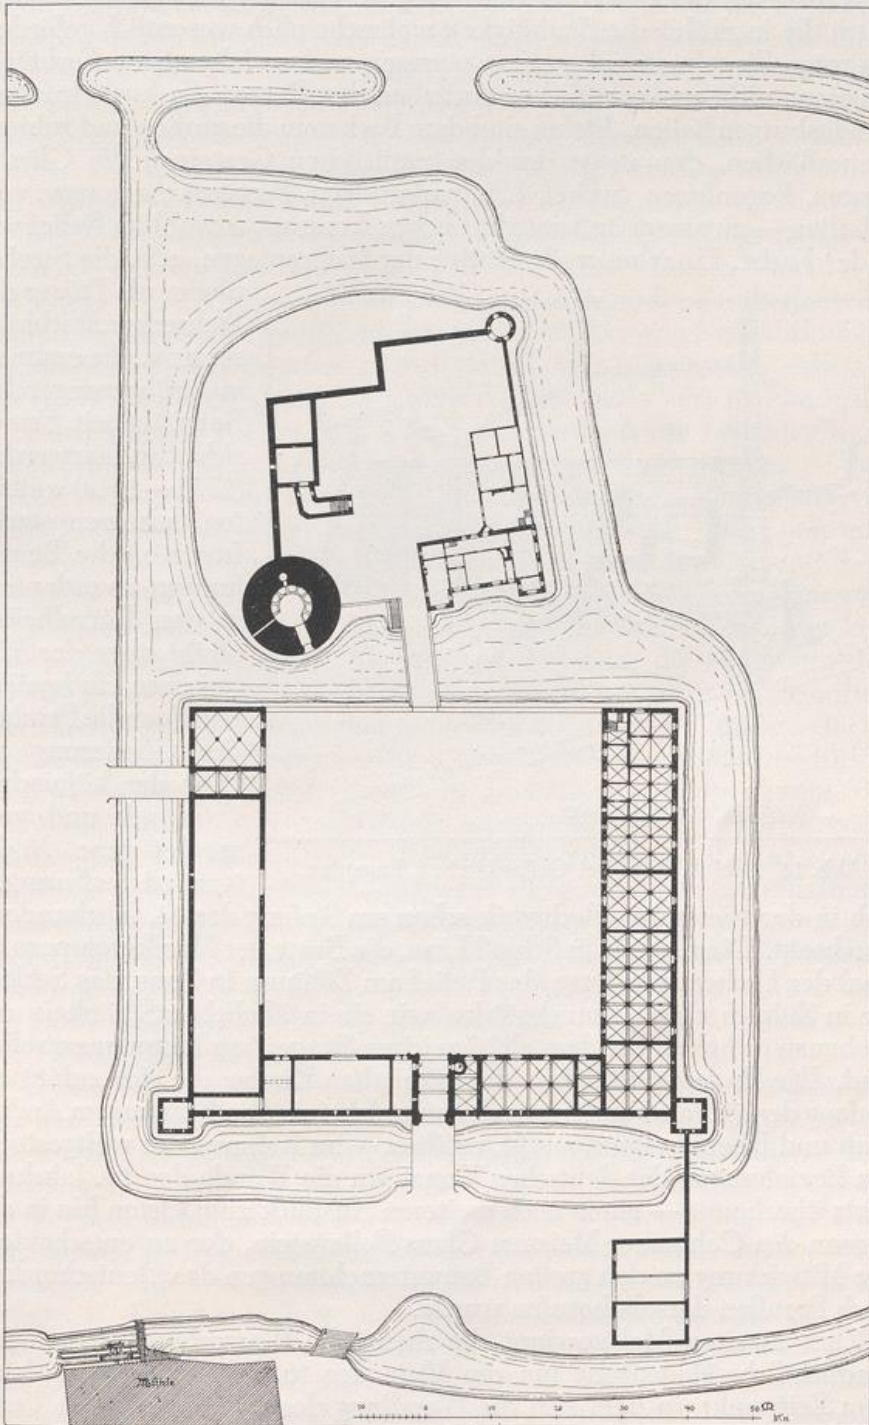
Schloß Müllenark, Grundriß. — Hochburg mit Batterieturm, Anfang des 16. Jahrhunderts, Vorburg 1670 (Wasserläufe ergänzt).
